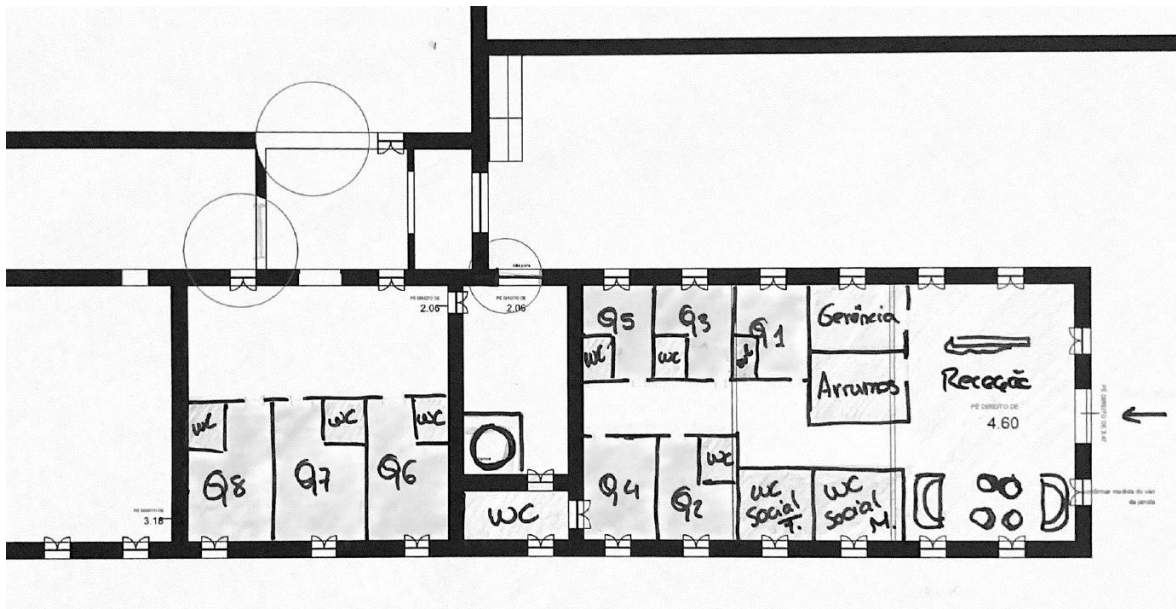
Primeiro Estudo de Proposta de Zonamentos
